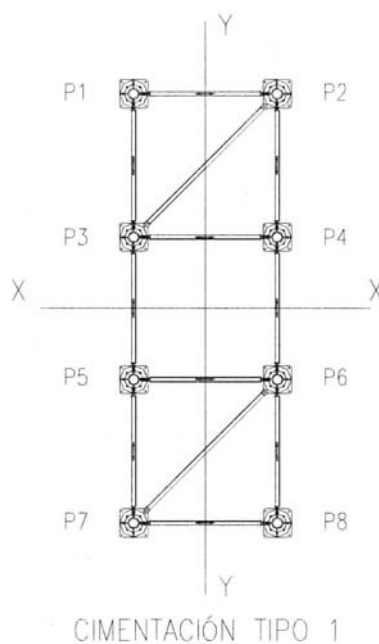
Esquema en planta de la torre de cimbra tipo 1 y numeración de los apoyos.
